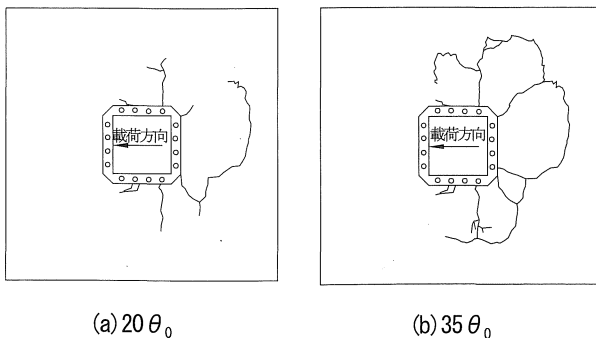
フーチングコンクリートひび割れ進展状況(単調荷重)
